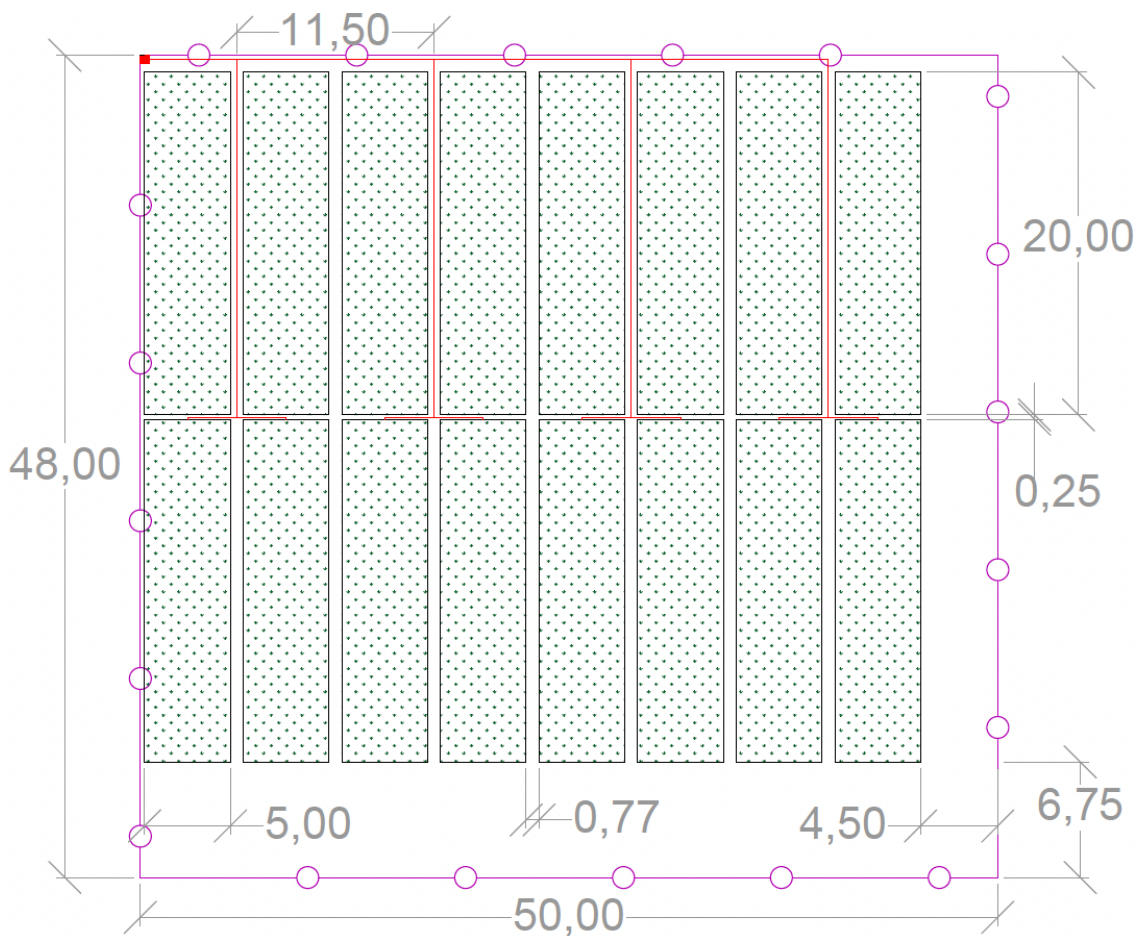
Distribución en planta de los sectores de riego y puntos más desfavorables del huerto. Fuente: Elaboración propia.
